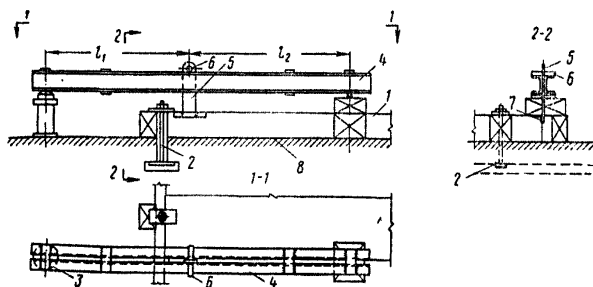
Схема устройства для проверки прочности заанкеривания закладных деталей
